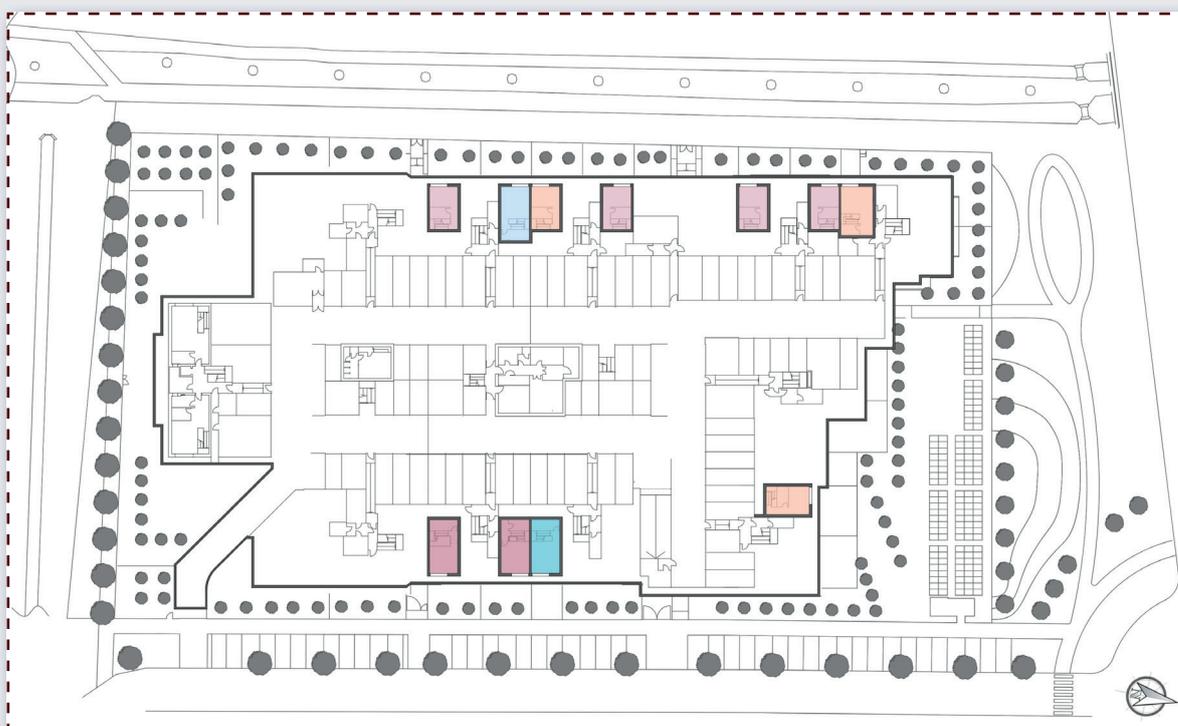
Planimetria piano sottotetto - profilo 2 e profilo 4
